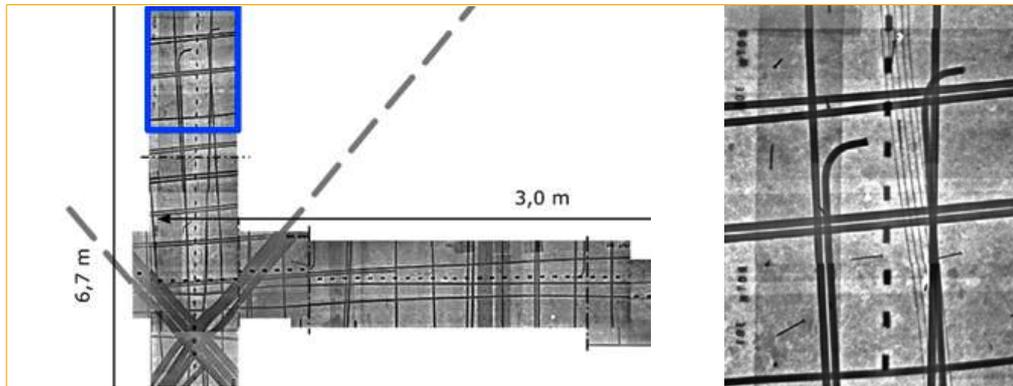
Fortsetzung: Untersuchung einer denkmalgeschützten Eisenbetondecke per Radiographie: Röntgenbilder der Lage des Glatteisens/Glattstahls mit Endaufbiegung zur Verankerung im Beton [Quelle: Dr.-Ing. Sebastian Schulze, bauray GmbH]
